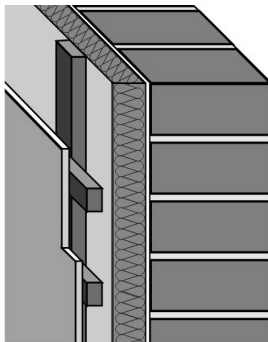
Einschalige Außenwand mit Bekleidung
